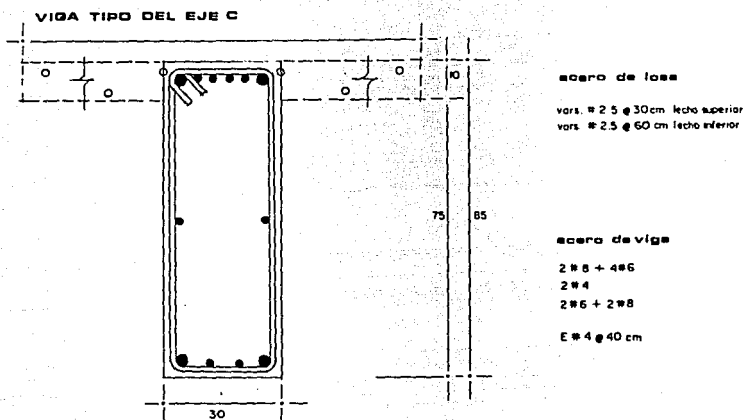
ARMADOS DE LAS SECCIONES TRANSVERSALES DE VIGAS TIPO DE LOS EJES C Y B
